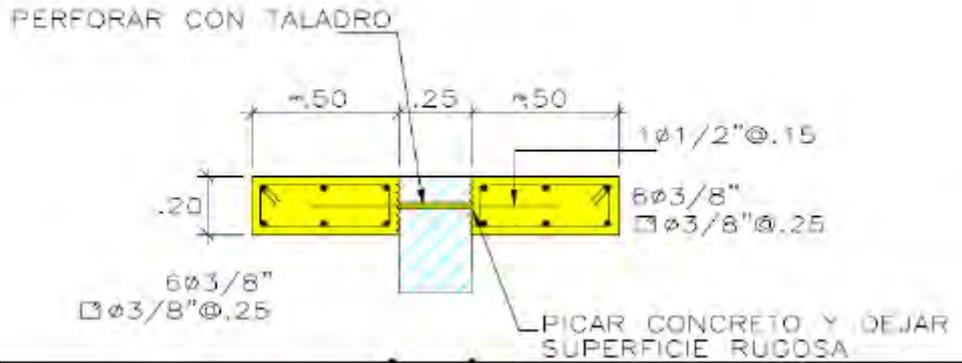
Detalle del refuerzo con aletas de concreto (Fuente: Informe DAI, 2007)
